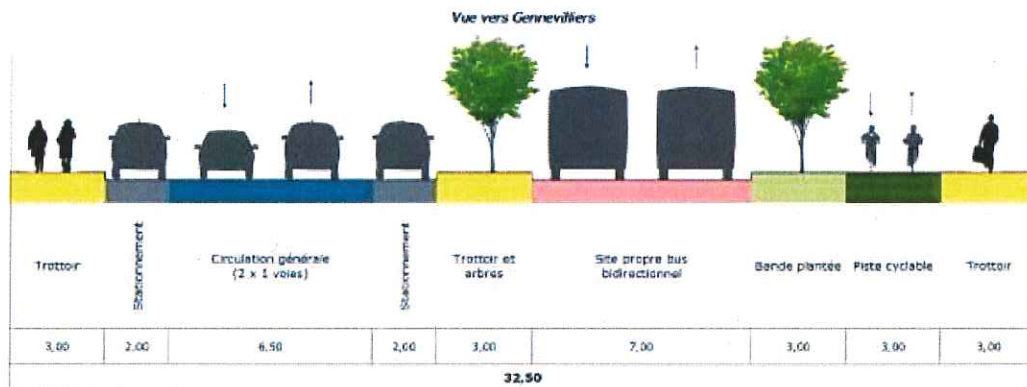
Coupe-type du scénario 1 – Site propre latéral Nord-Est
